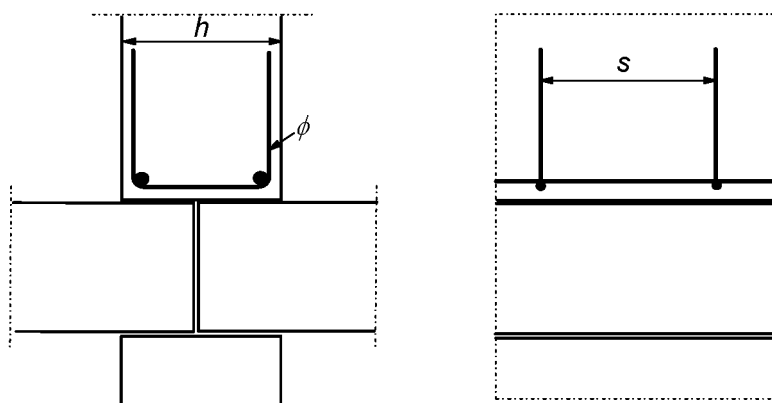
Ejemplo de armadura en un muro sobre la conexión entre dos losas del forjado
